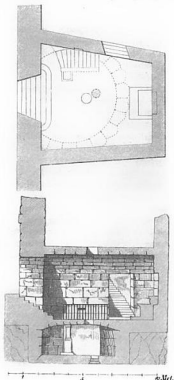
Grundriss und Durchschnitt des Tullianum.
